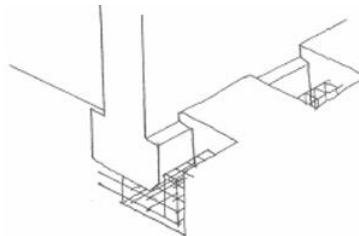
Execução de armadura nos troços escavados de um dos lados de fundação (11).
